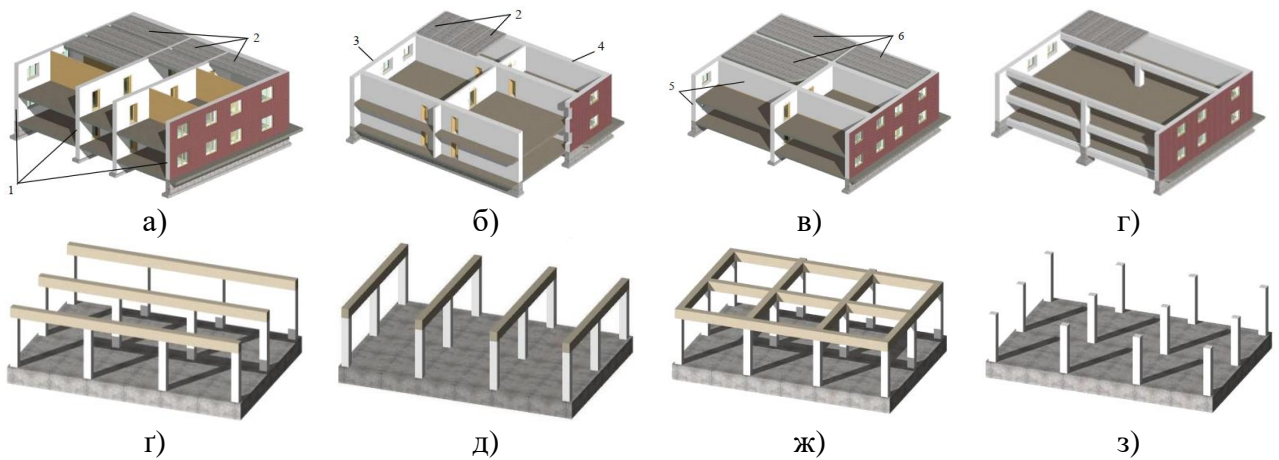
Конструктивні схеми будівель: а – безкаркасна з повздовжнім розташуванням несучих стін; б – безкаркасна з поперечним розташуванням несучих стін; в – безкаркасна з перехресним розташуванням несучих стін; г – з неповним каркасом при поперечному розташуванні ригелів; г – повнокаркасна з повздовжнім розташуванням ригелів; д – повнокаркасна з поперечним розташуванням ригелів; ж – повнокаркасна з перехресним розташуванням ригелів; з – повнокаркасна безригельна; 1 – зовнішня та внутрішня стіни; 2 – панелі міжповерхових перекриттів; 3 – самонесучі зовнішні стіни; 4 – несуча стіна торця; 5 – несучі стіни (повздовжні та поперечні); 6 – плита перекриття, обперта по контуру
